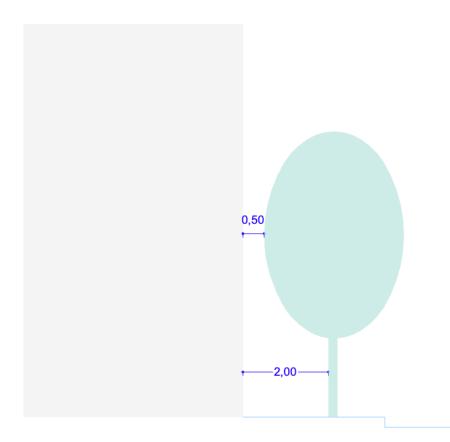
Distancias mínimas a respetar con la edificación (fachada y balcones). Cotas en metros lineales (m)
